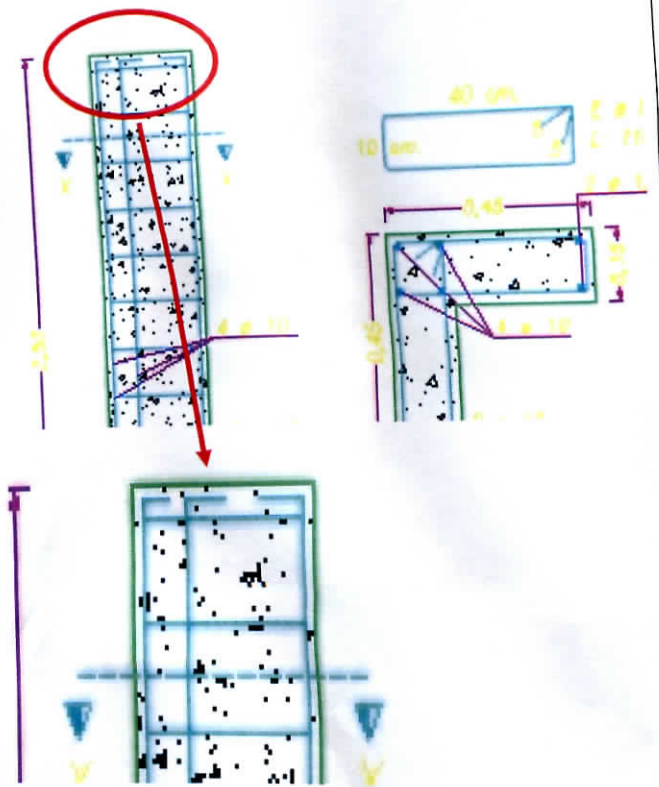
Altura de pilares de hormigón del cierre perimetral del proyecto e imagen de la altura especificada de los pilares de cierre en plano estructural lámina EST 1 de 3, altura 2,5 m.
